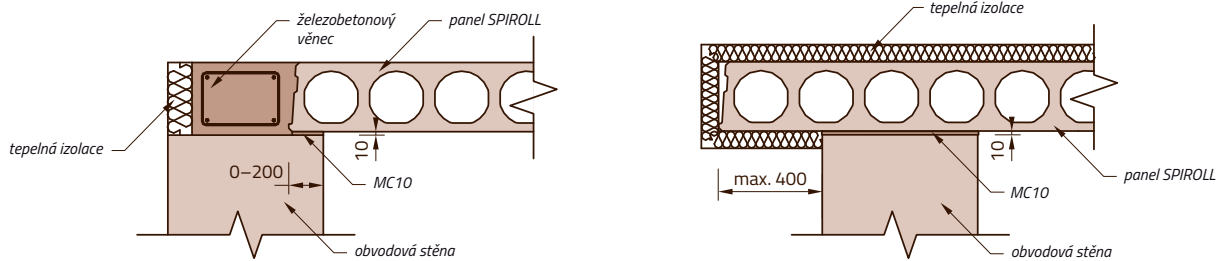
3: Panely SPIROLL výšky 320 a 400 mm
